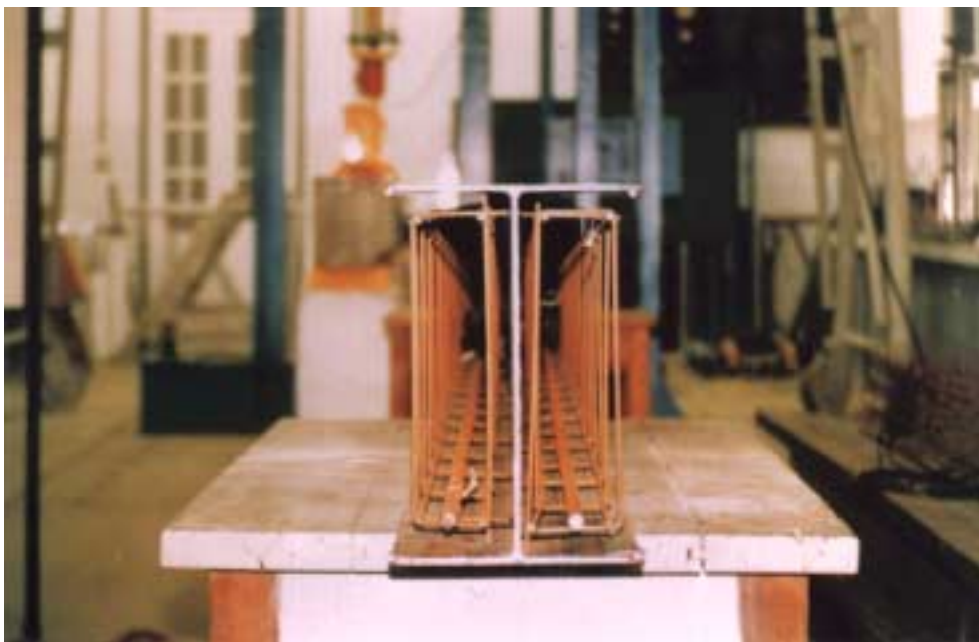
Ilustração da Viga VS1 (perfil de aço com armaduras)
